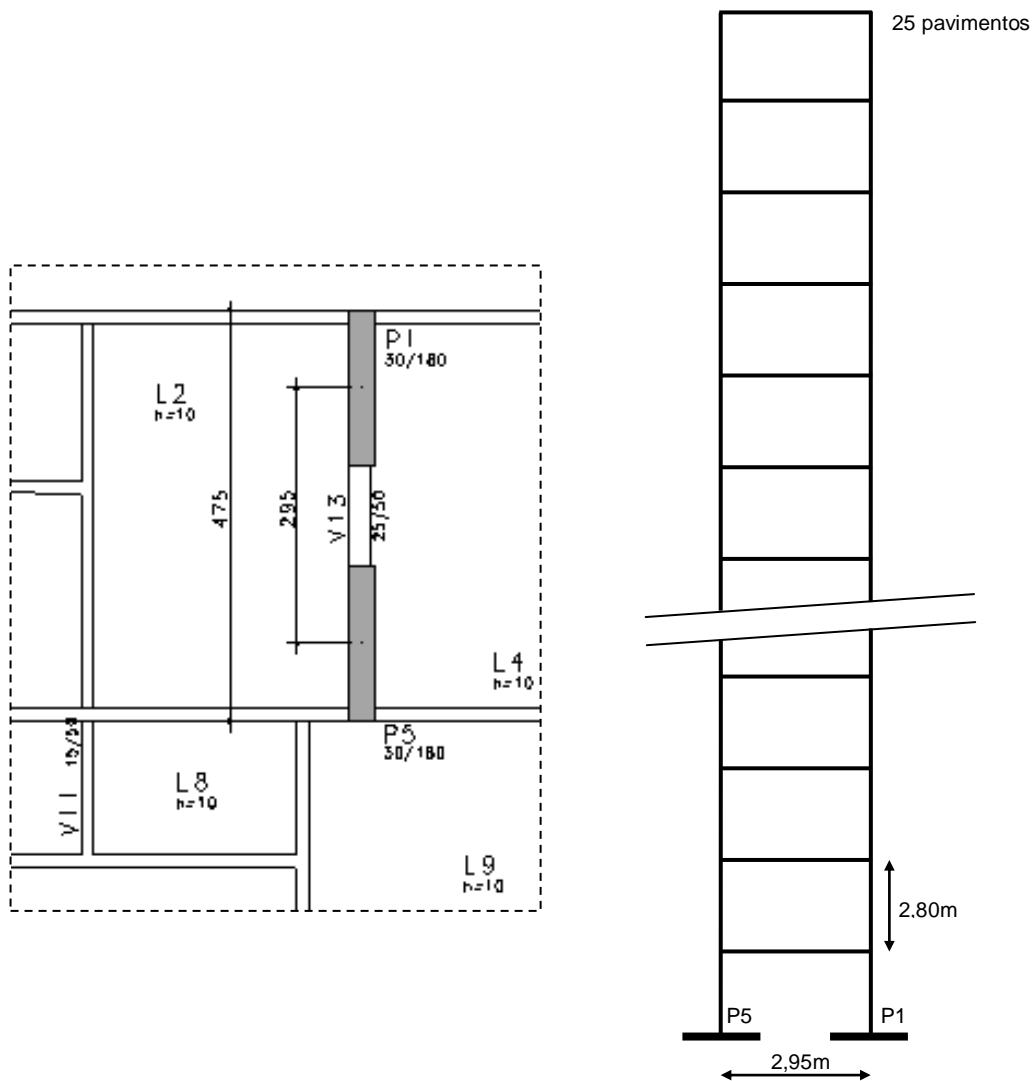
Trecho da planta baixa de forma e pórtico plano – Edifício 1
